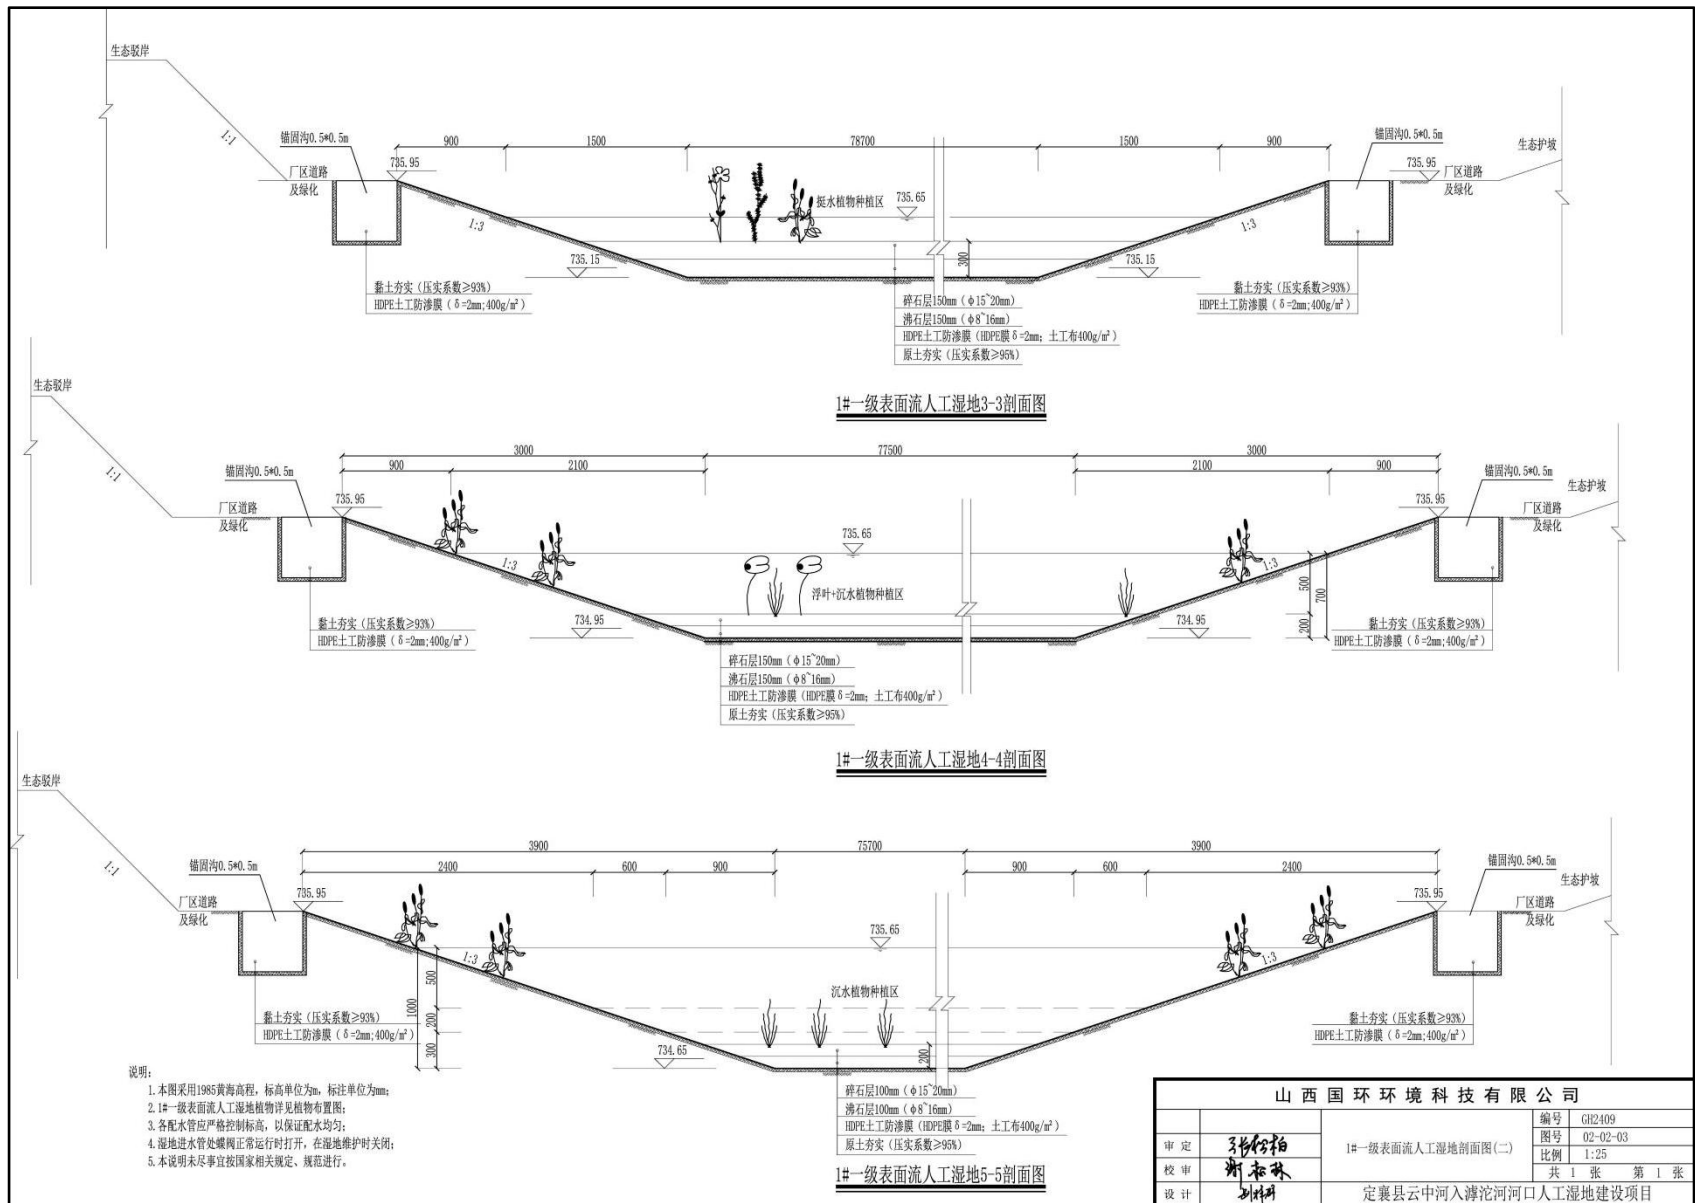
1#一级表面流人工湿地剖面图 (2)
